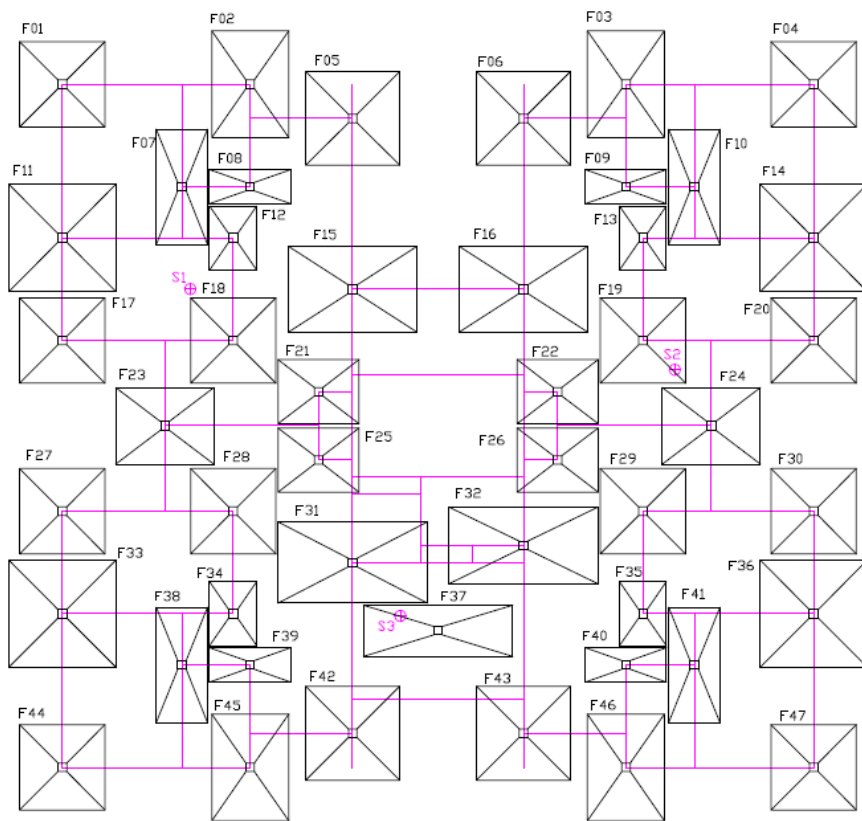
Planta de fundação rasa para o edifício quadrado.
